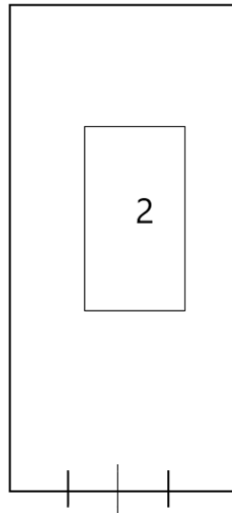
План размещения пожарной нагрузки в серверной
